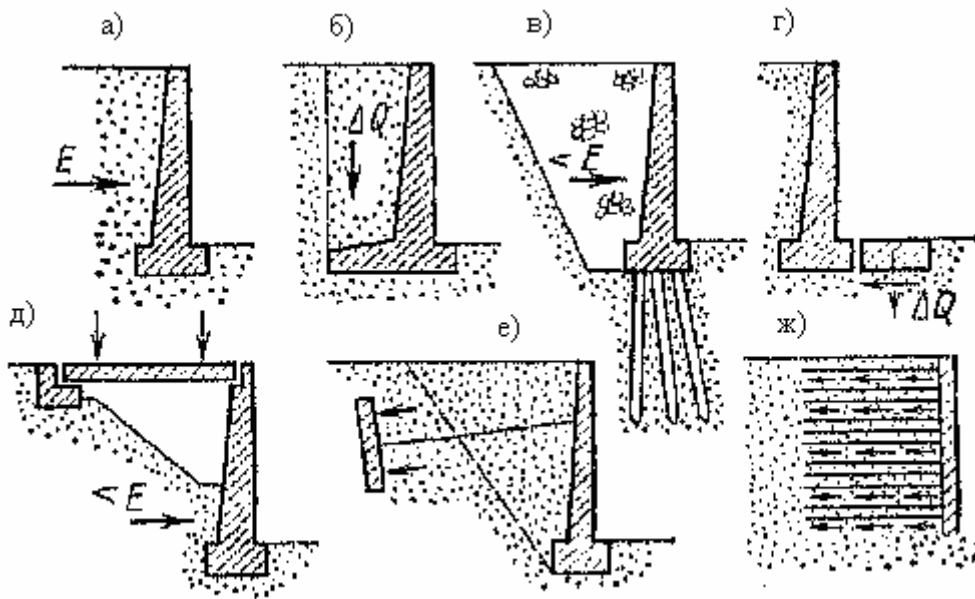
Основные схемы повышения устойчивости подпорной стенки: а – типовая конструкция подпорной стены; б – засыпка крупнозернистым материалом; в – применение свайных конструкций; г – устройство упоров; д – устройство разгрузочных плит; е – устройство анкерных плит; ж – применение армированного грунта
